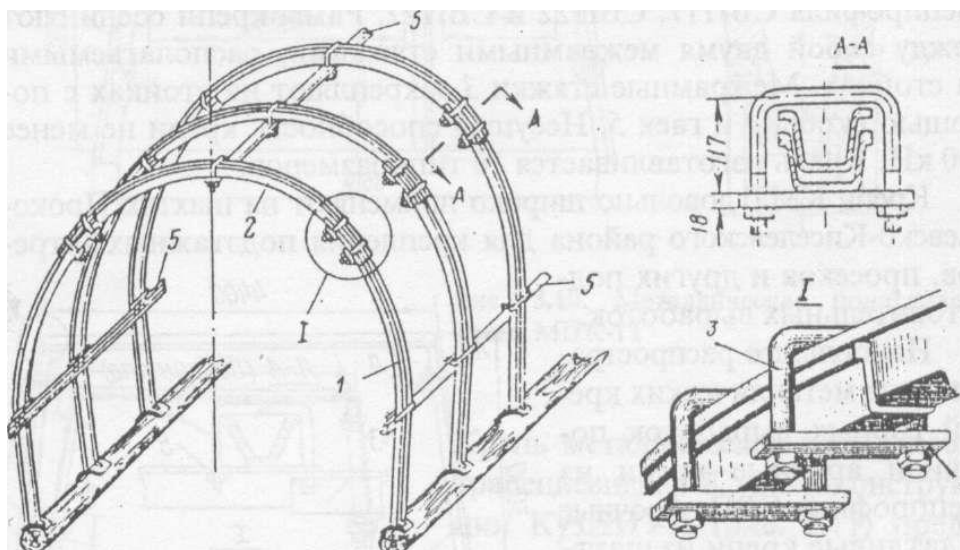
Трехзвенная арочная крепь из спецпрофиля: 1 – стойка; 2 – верхний сегмент; 3 – хомут; 4 – планка с гайками; 5 – стяжки
